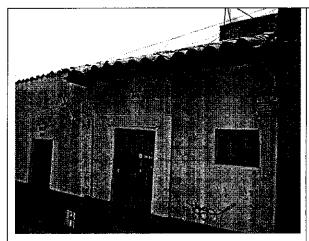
Aspecto general de la fachada (costado sur) de la edificación emplazada en el predio de la Calle 8 No. 0-20.
